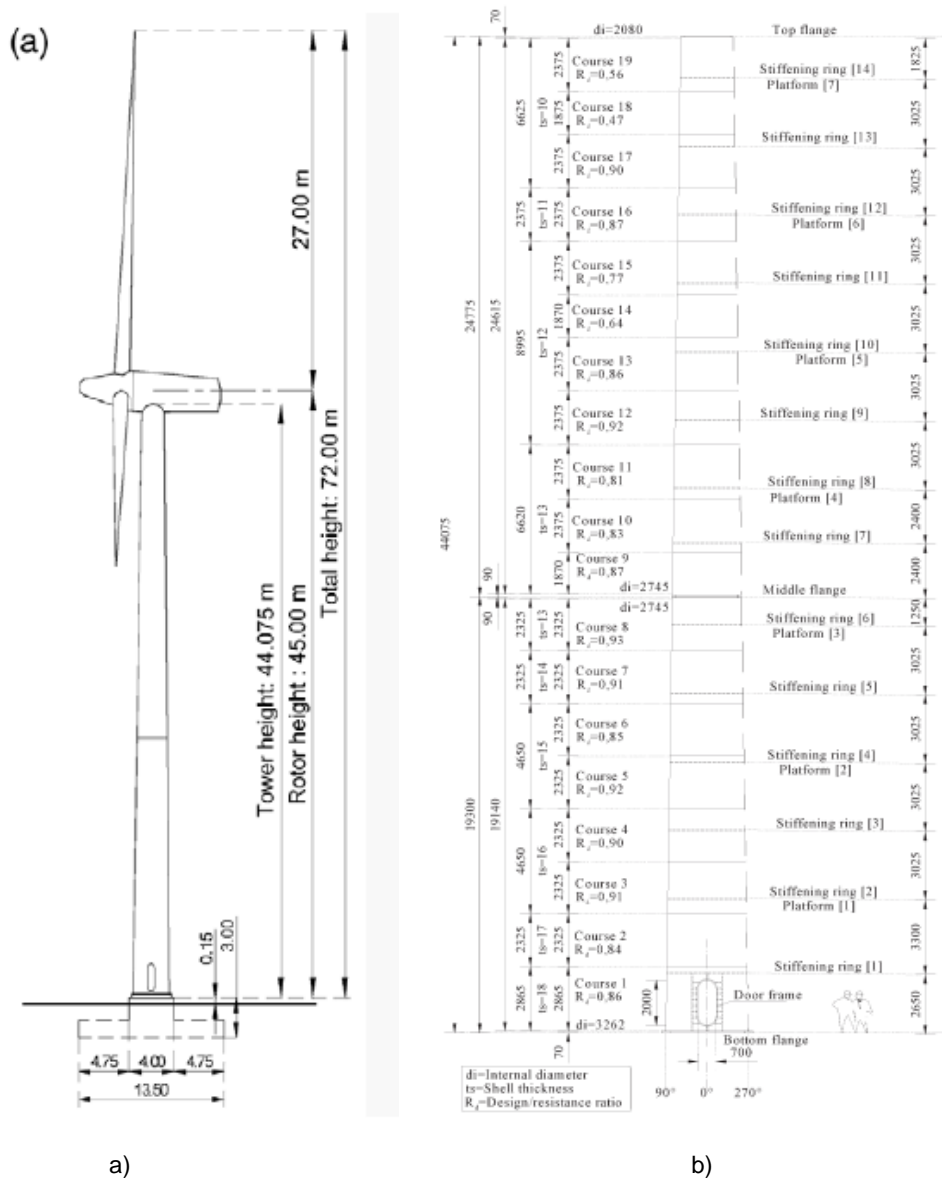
a) Dimensões da torre eólica; b) Torre em pormenor [25]
